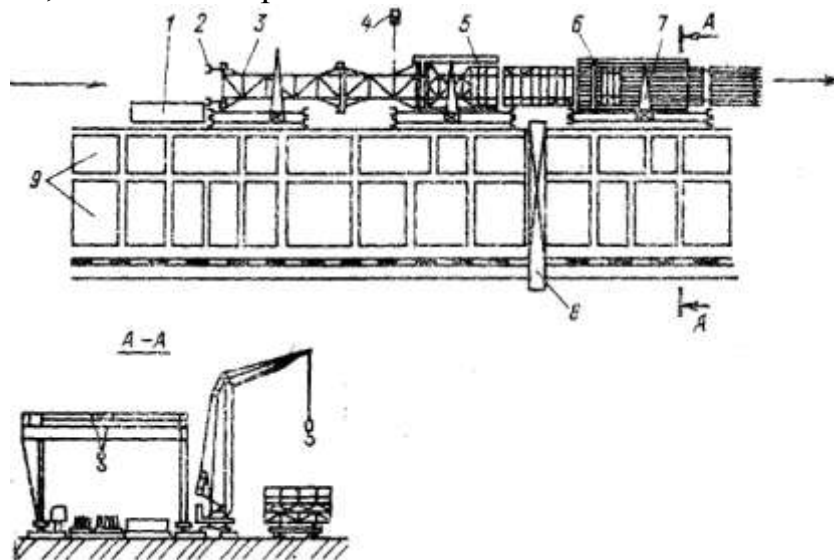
Схема конвейерной линии с продольным расположением потока для сборки и сварки на монтаже блоков покрытий промышленных зданий
